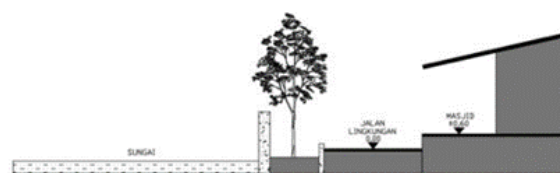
Ilustrasi Potongan Orientasi Bangunan Eksisting
